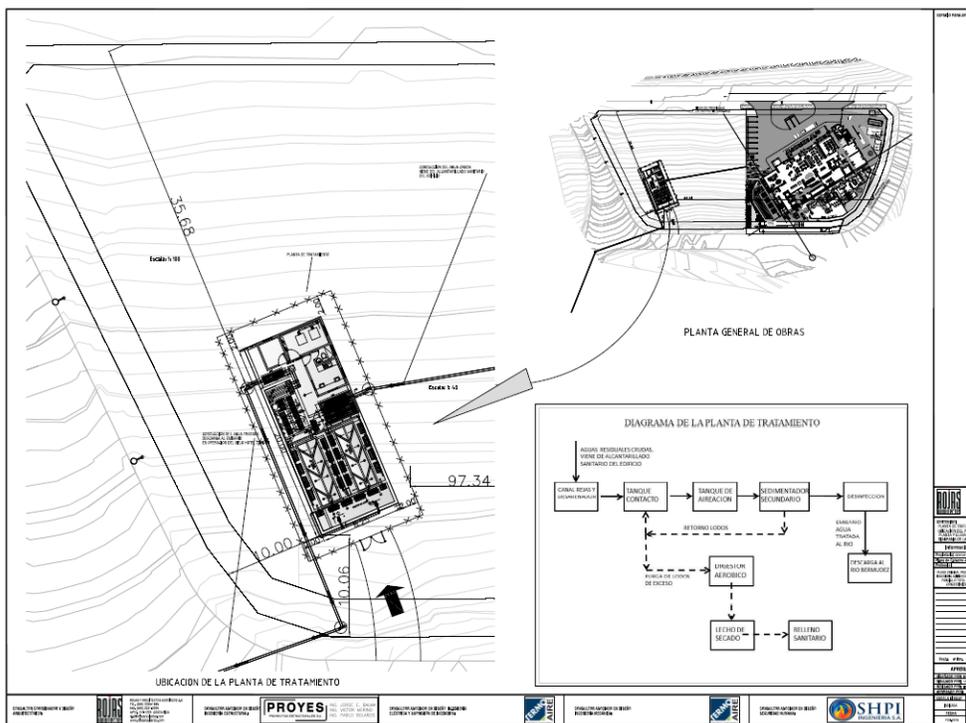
Ubicación de Sistema de Planta de Tratamiento Referencia Lámina # IS-2 de planos constructivos.
